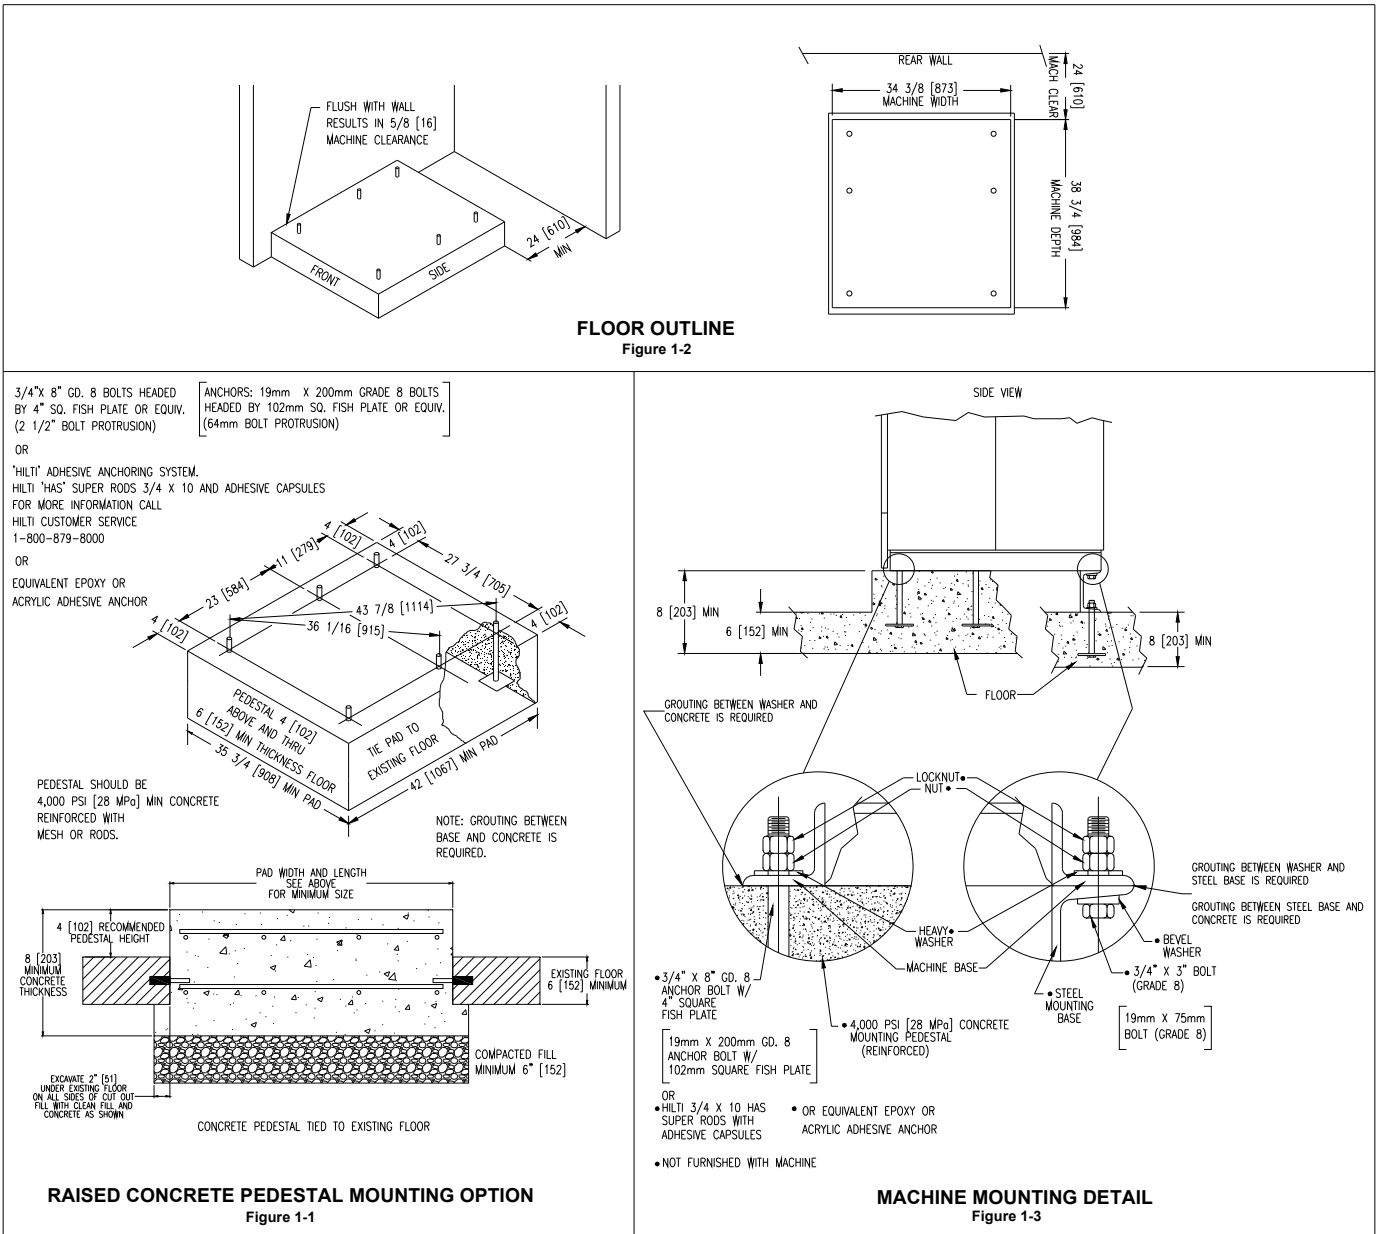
Dettaglio del montaggio del macchinario T-900
